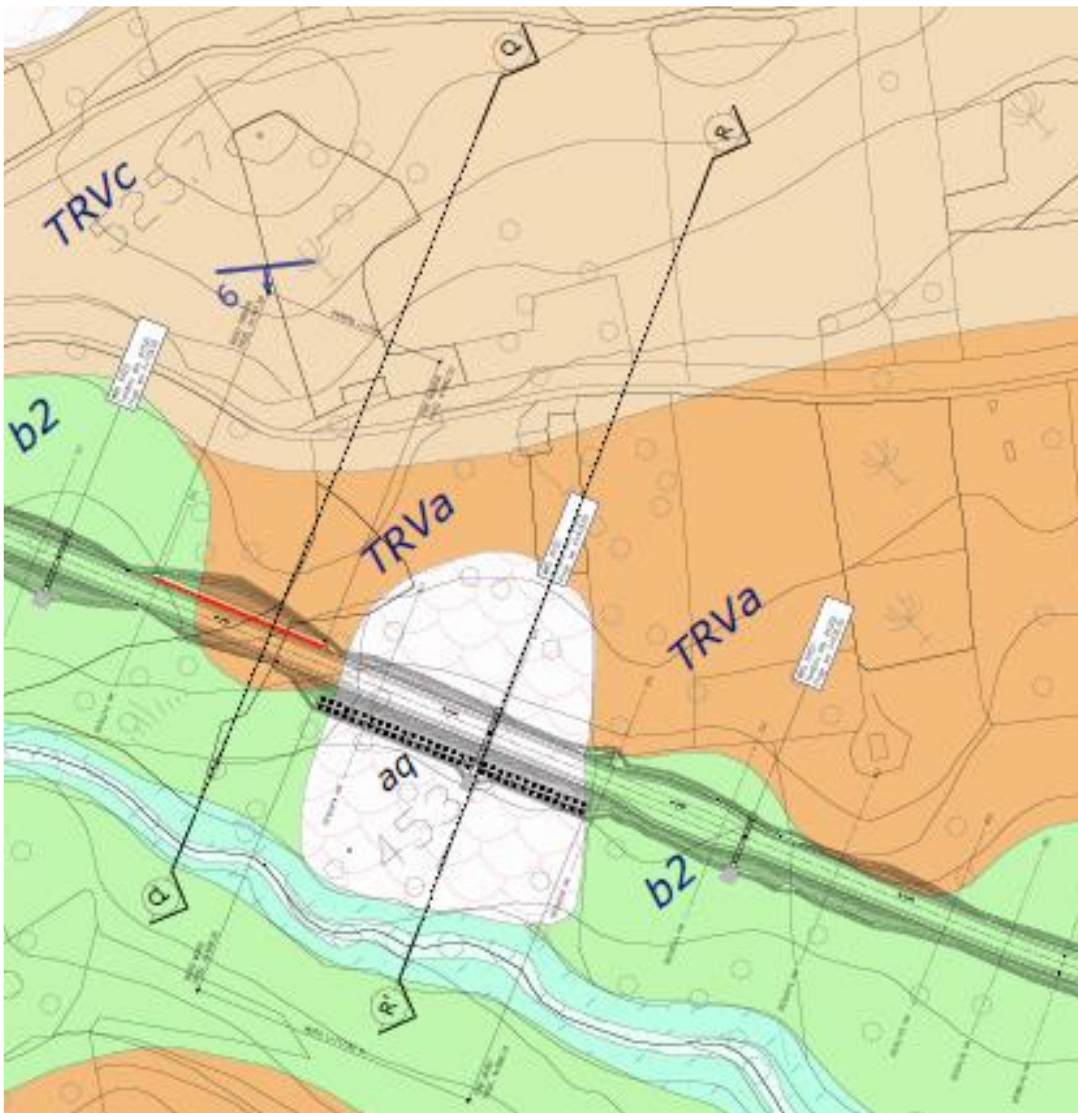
STRALCIO PLANIMETRICO DELL'OPERA IN PROGETTO
